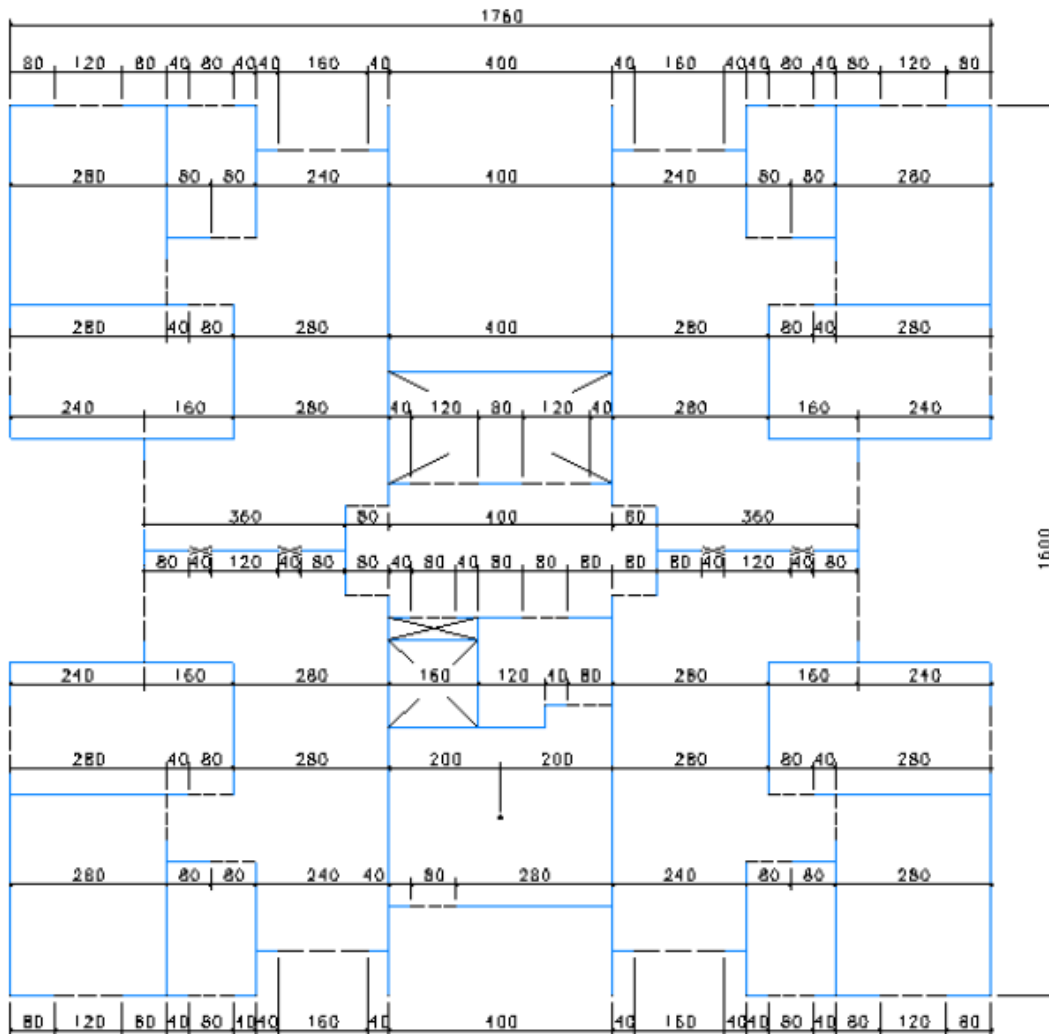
Cotas horizontais - cm (Fonte: Braguim, 2013).
